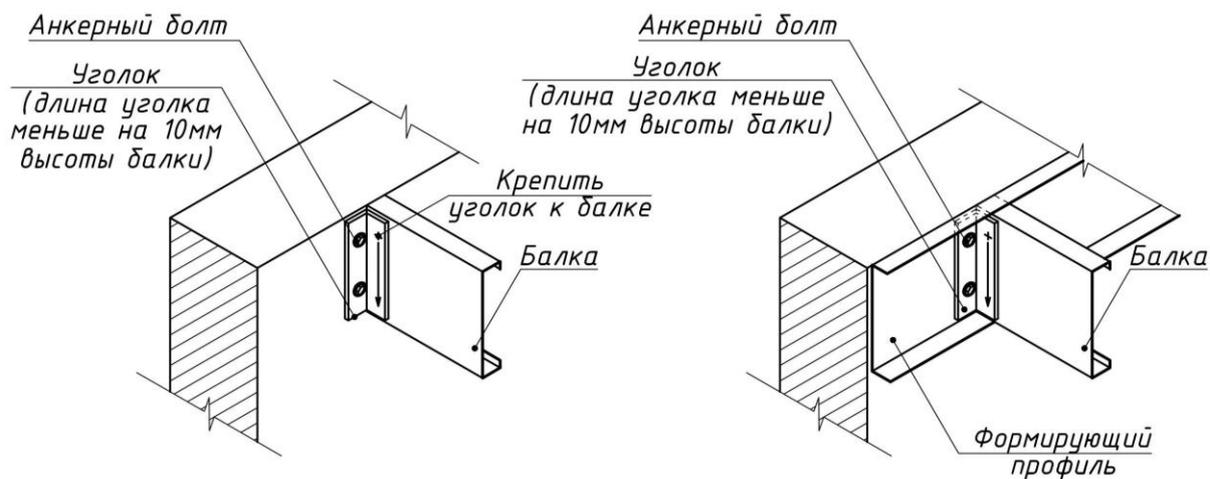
Узел П 3. Крепление перекрытия к нагруженной опорной стене
